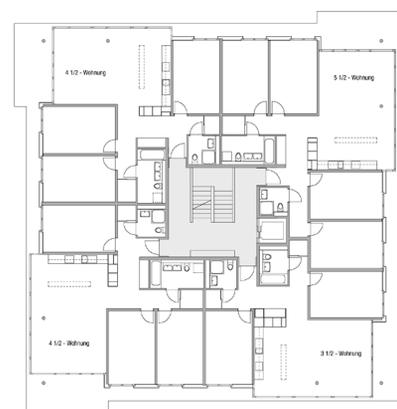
Wohnüberbauung Steinacker, Grundriss, Geschoße 1-3
